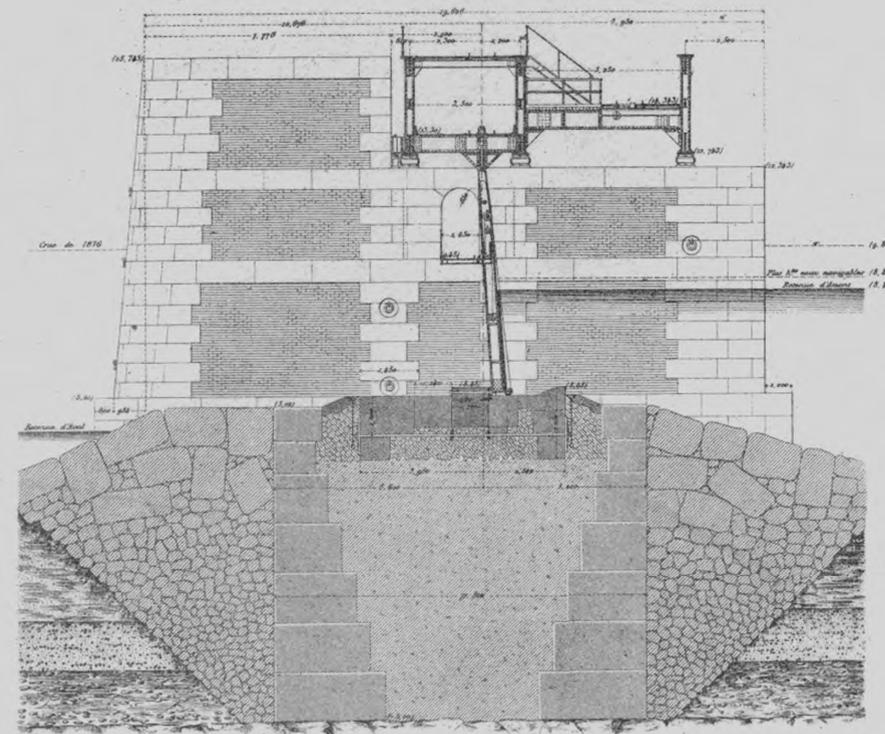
Coupe d'une passe profonde non navigable s: K L et Elevation de la culée rive droite.
